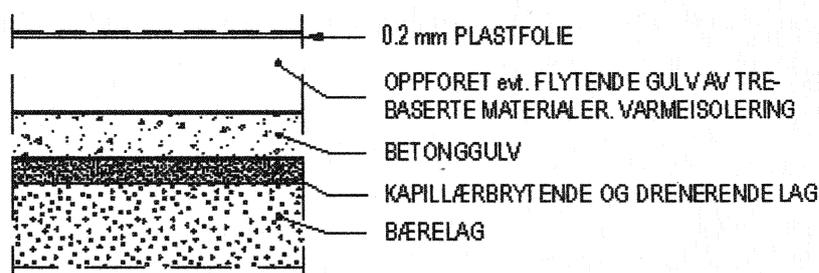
c: Betonggulv med oppføret eller flytende (isolert) gulv på oversiden.
